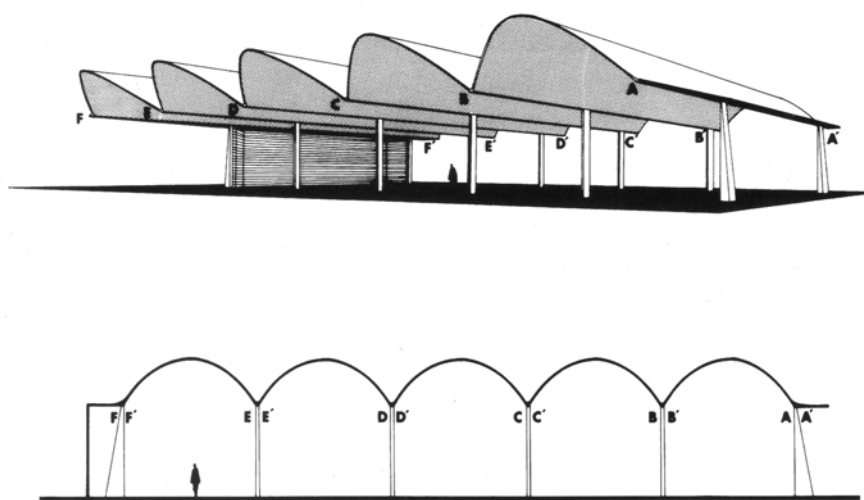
Desenho com abóbadas autoportantes apoiadas em pilares de concreto armado.
